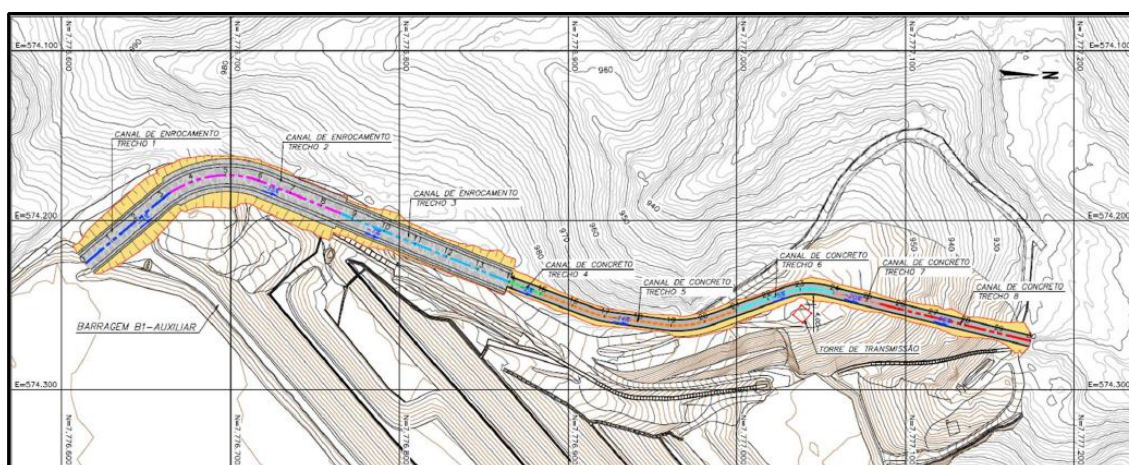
Canal de Desvio - Alternativa 2 - Planta. Fonte: IPE.OP.RL.8000.GT.20.1522.
